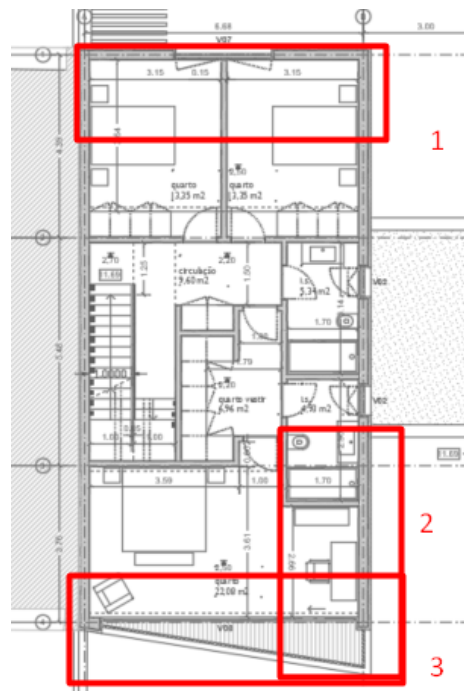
Planta do Piso 1 (Fonte: Blackcurrant (adaptado))
